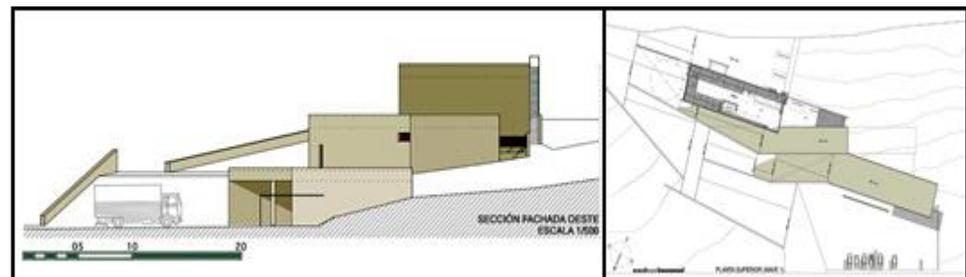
Sección longitudinal – Ilustración: Archdaily.pe
